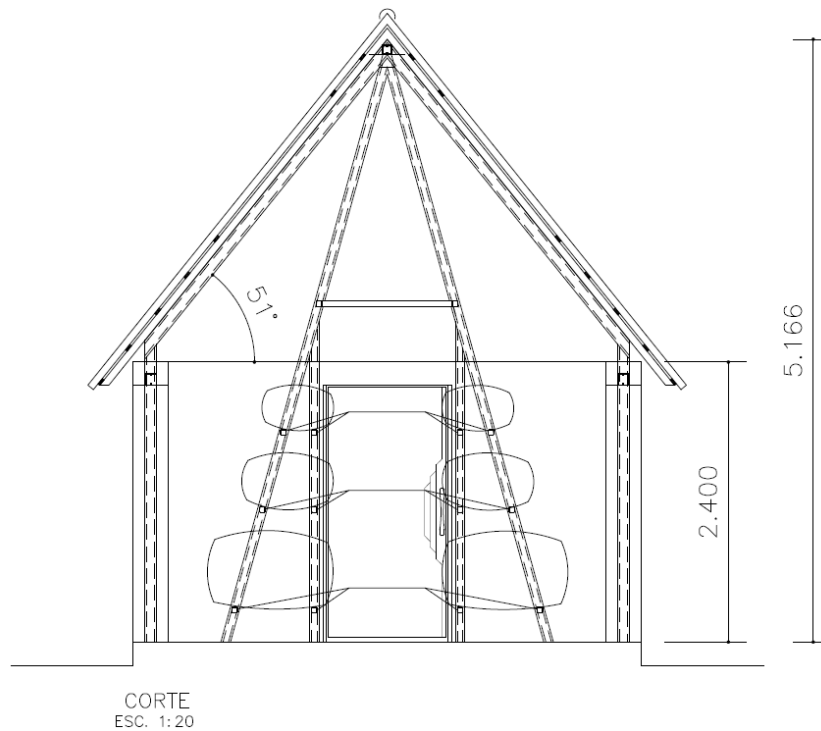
Estrutura metálica de sustentação dos barris – vista frontal.
